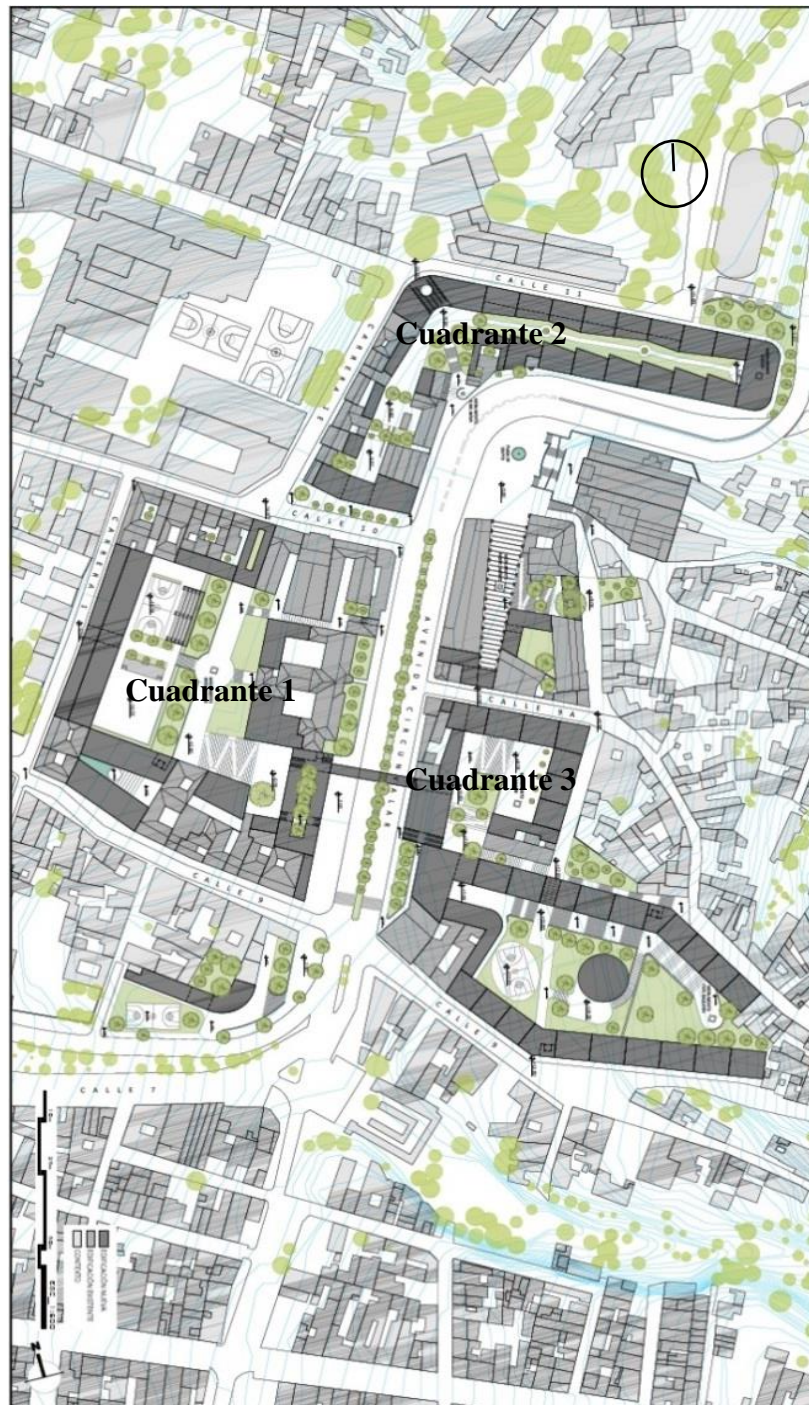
Planta General Propuesta Intervención. Fuente: Propia.
